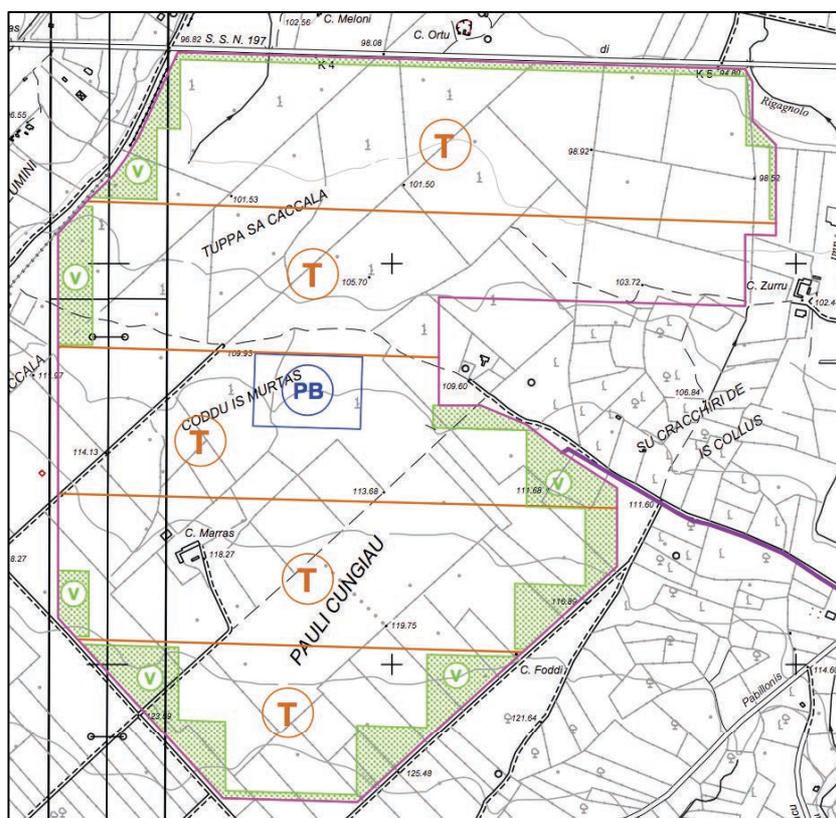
Rappresentazione planimetrica dei terrazzamenti (estratto della tavola GN_TAV.PU_01)
